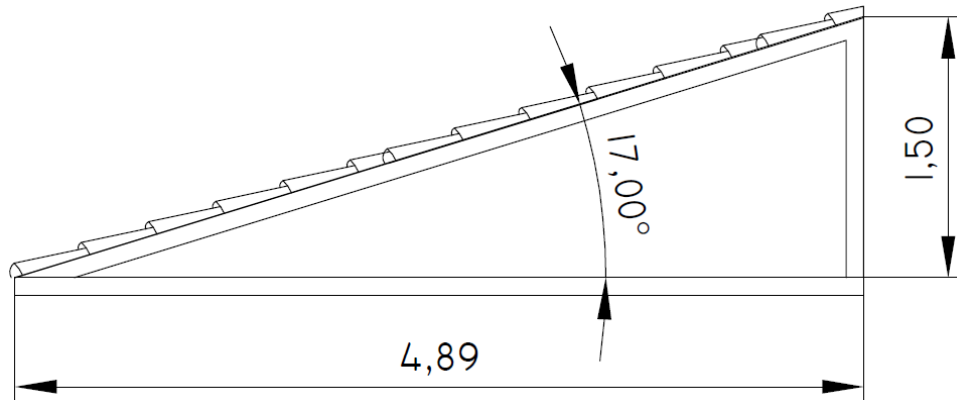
Vista lateral do madeiramento do telhado, detalhando o ângulo de inclinação do mesmo. (DOS AUTORES)
